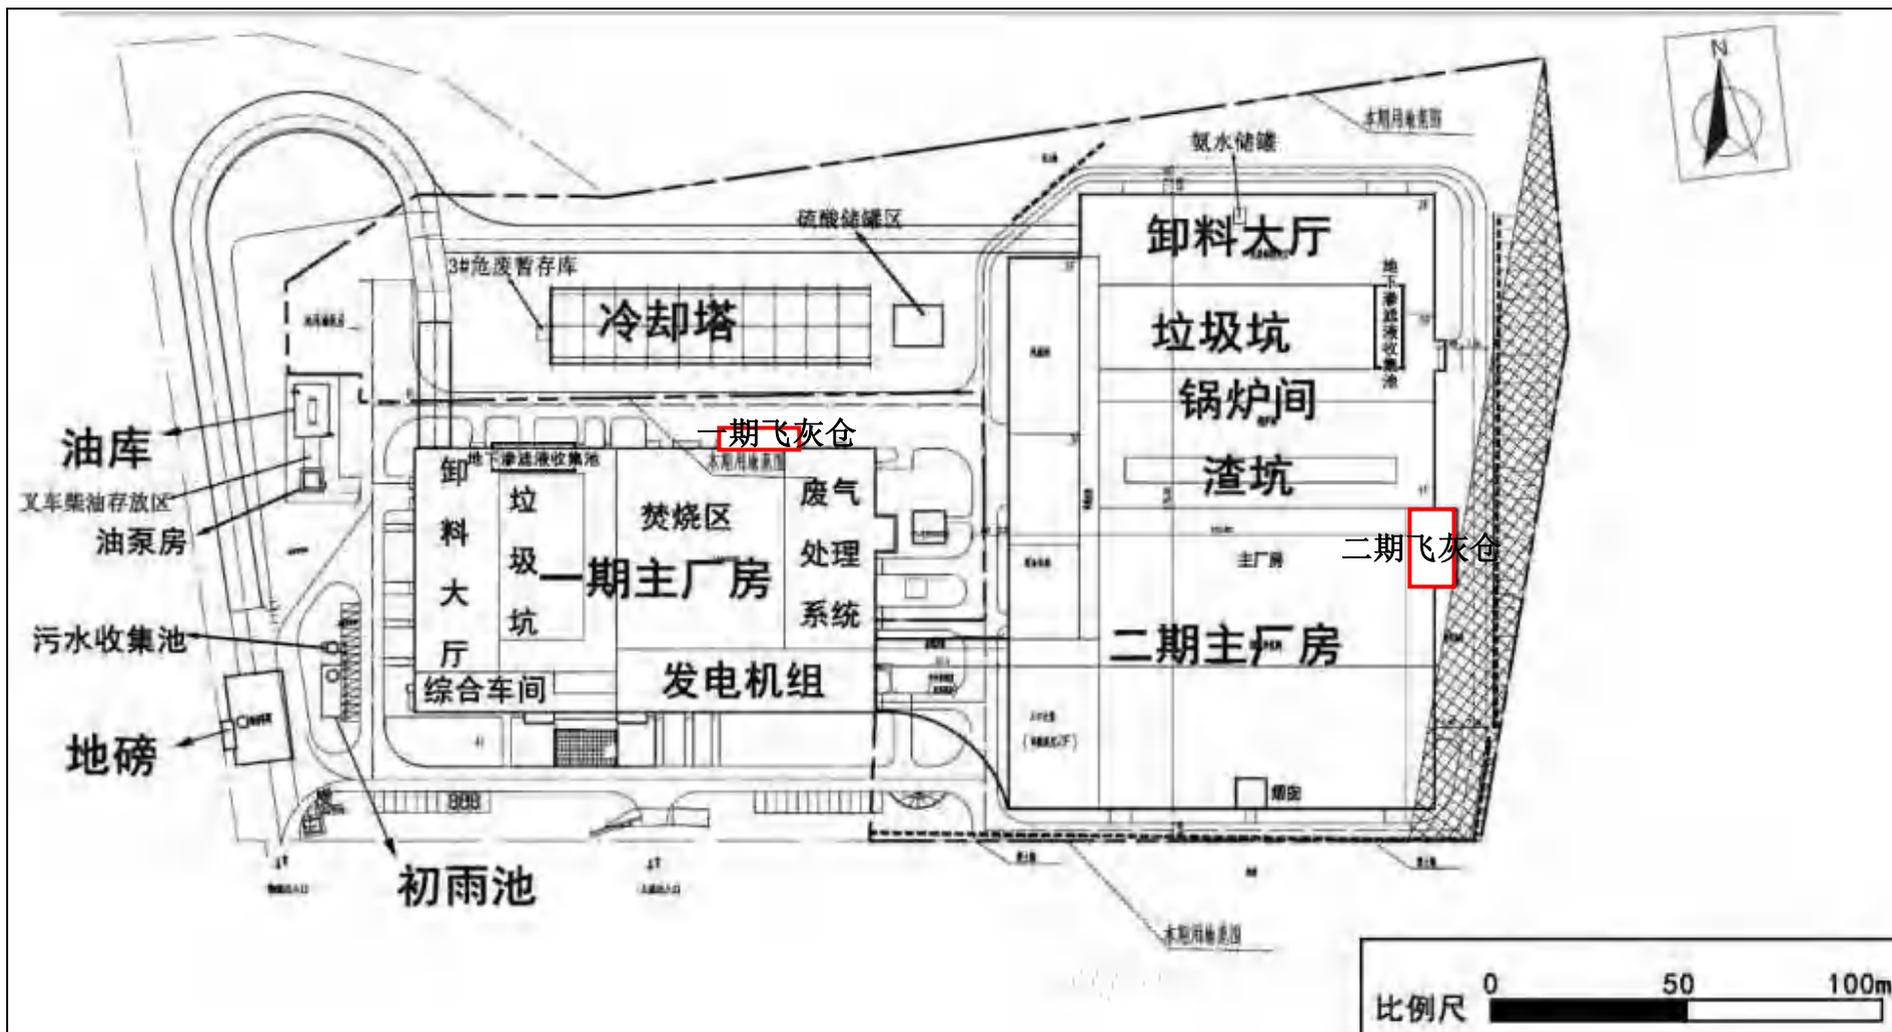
现有项目平面布置图（焚烧发电厂区）
